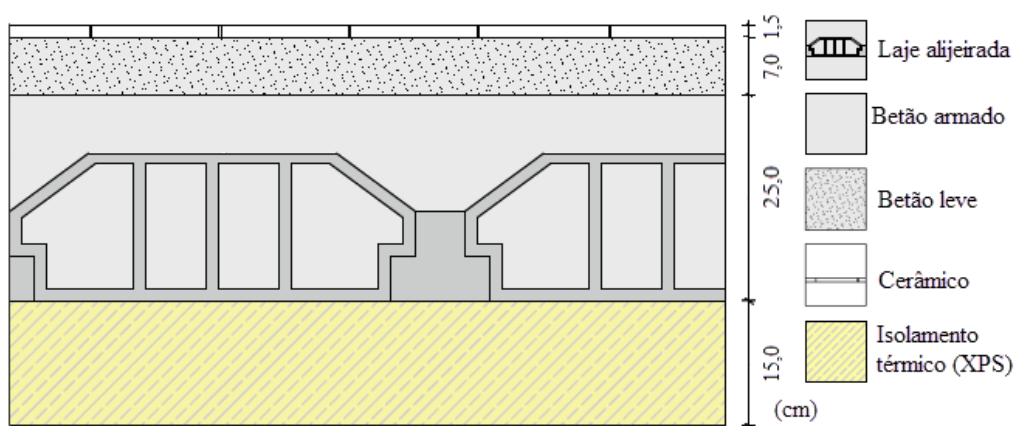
Solução construtiva de laje de piso sobre desvão ventilado
